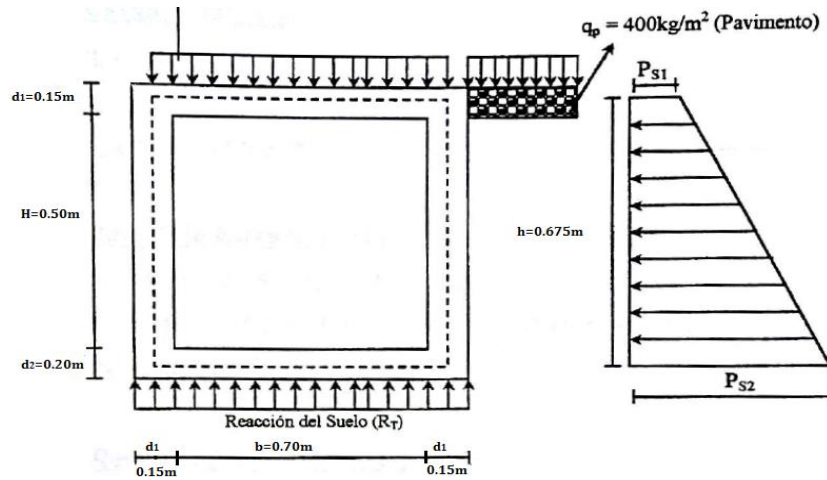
Sistemas de cargas en las alcantarillas (Fuente: Coeficiente Maning).
